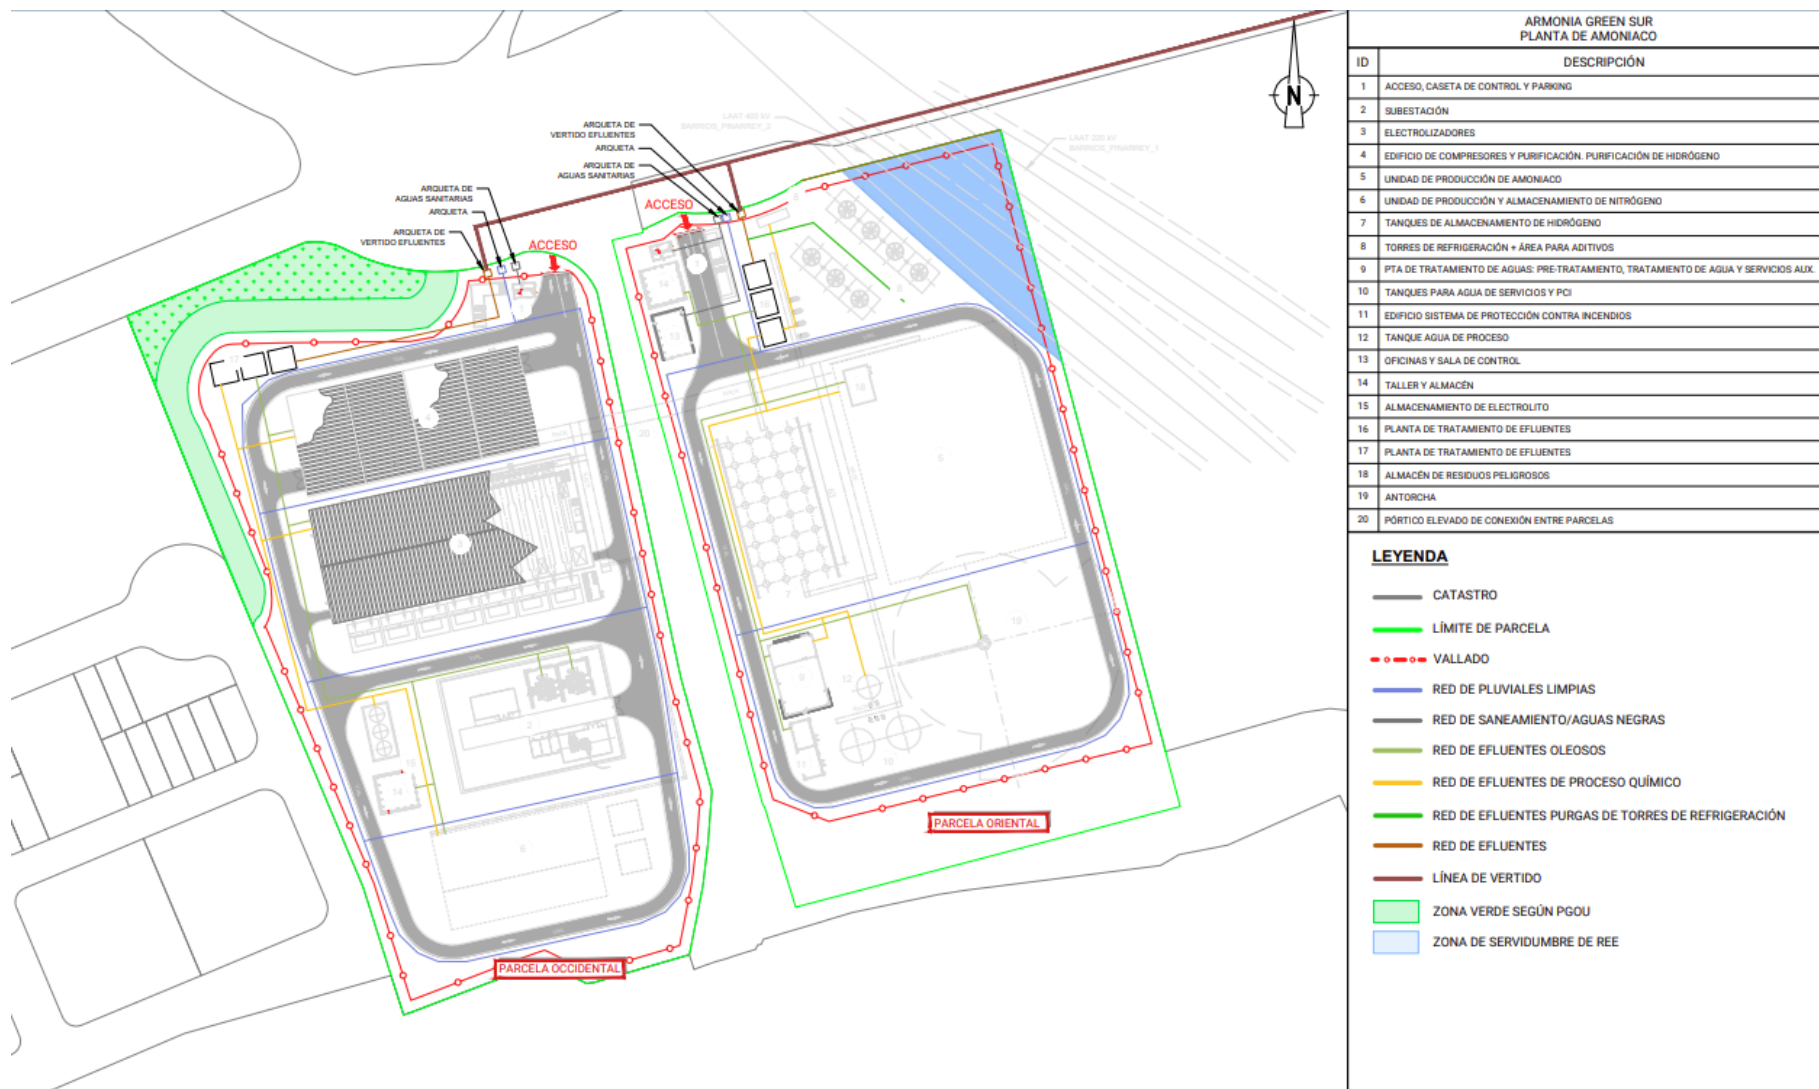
Diseño de la red de drenaje de la Planta. Fuente: Proyecto Básico.
